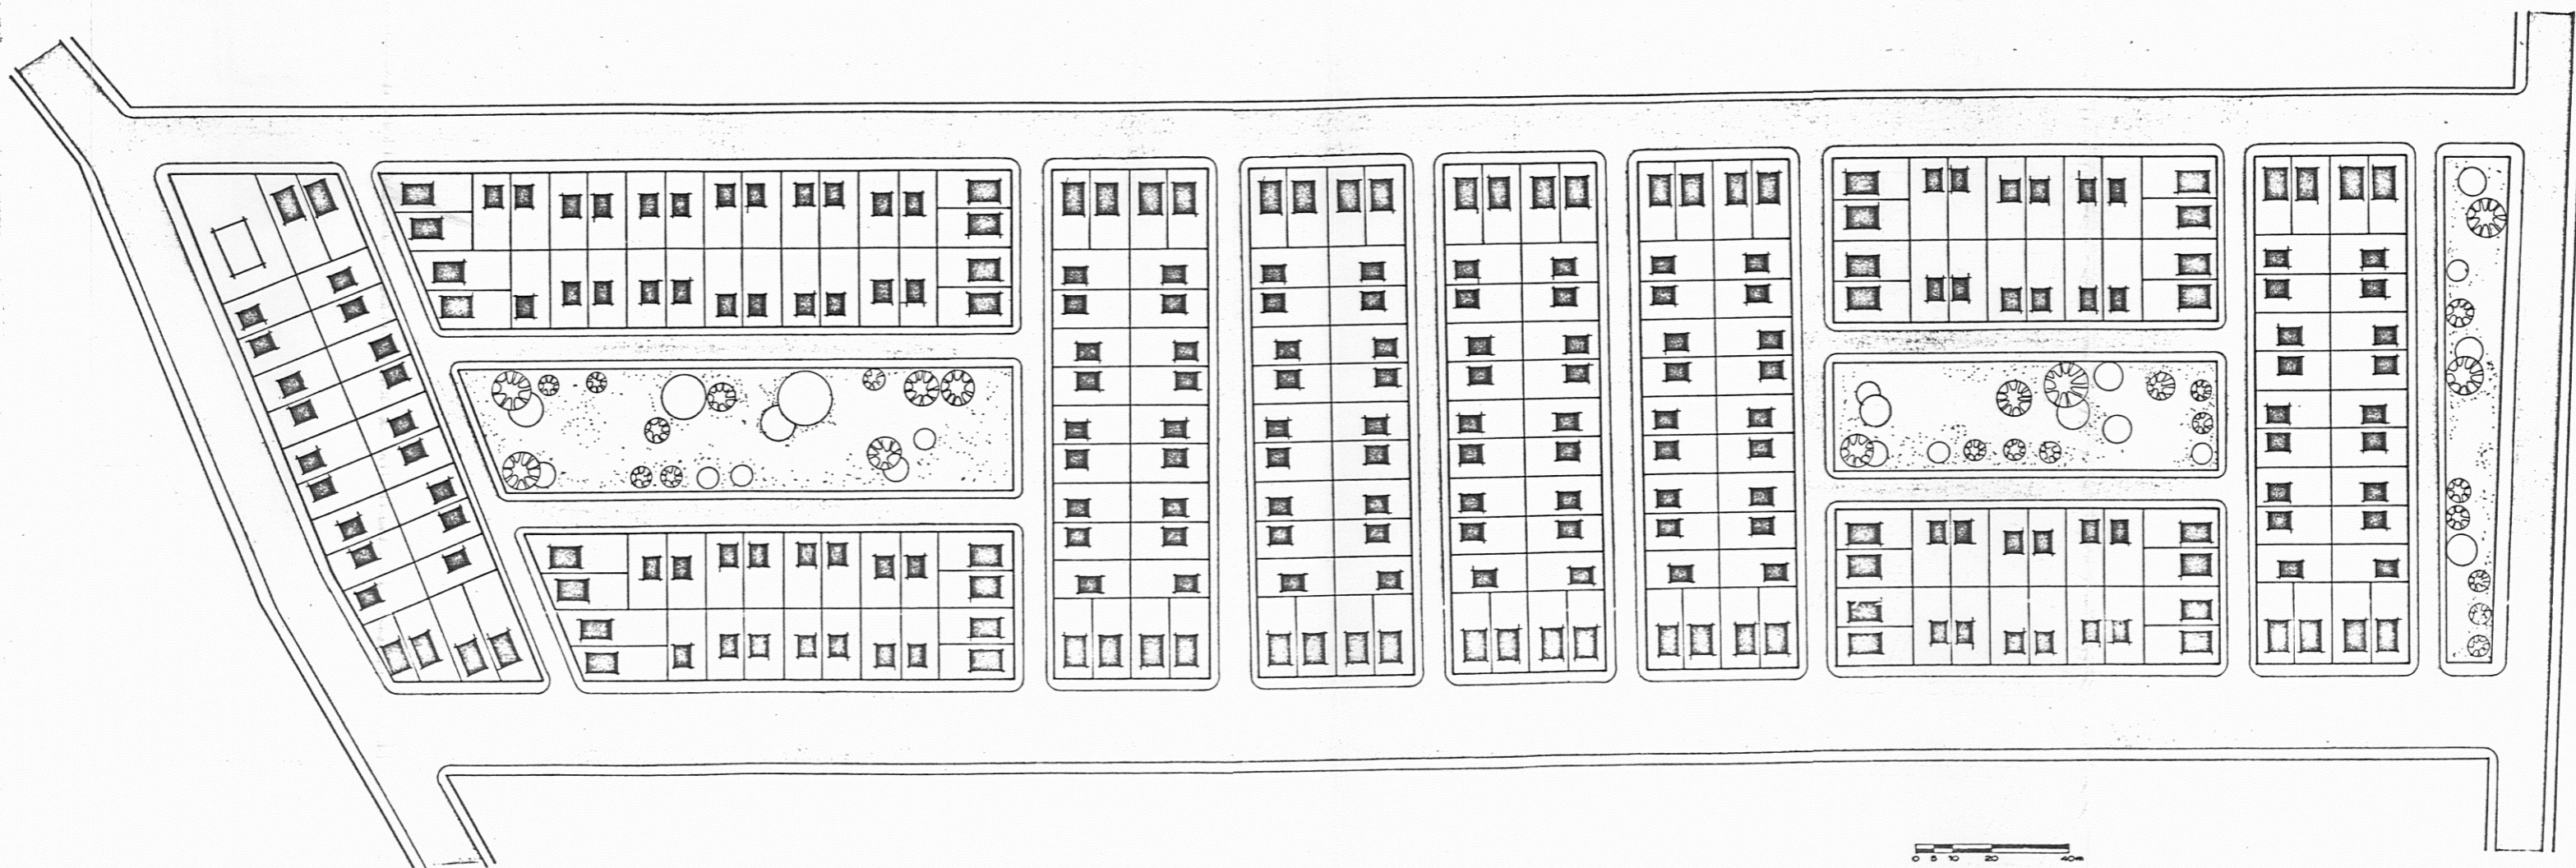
Concepção urbanística existente - COHAB-RS
